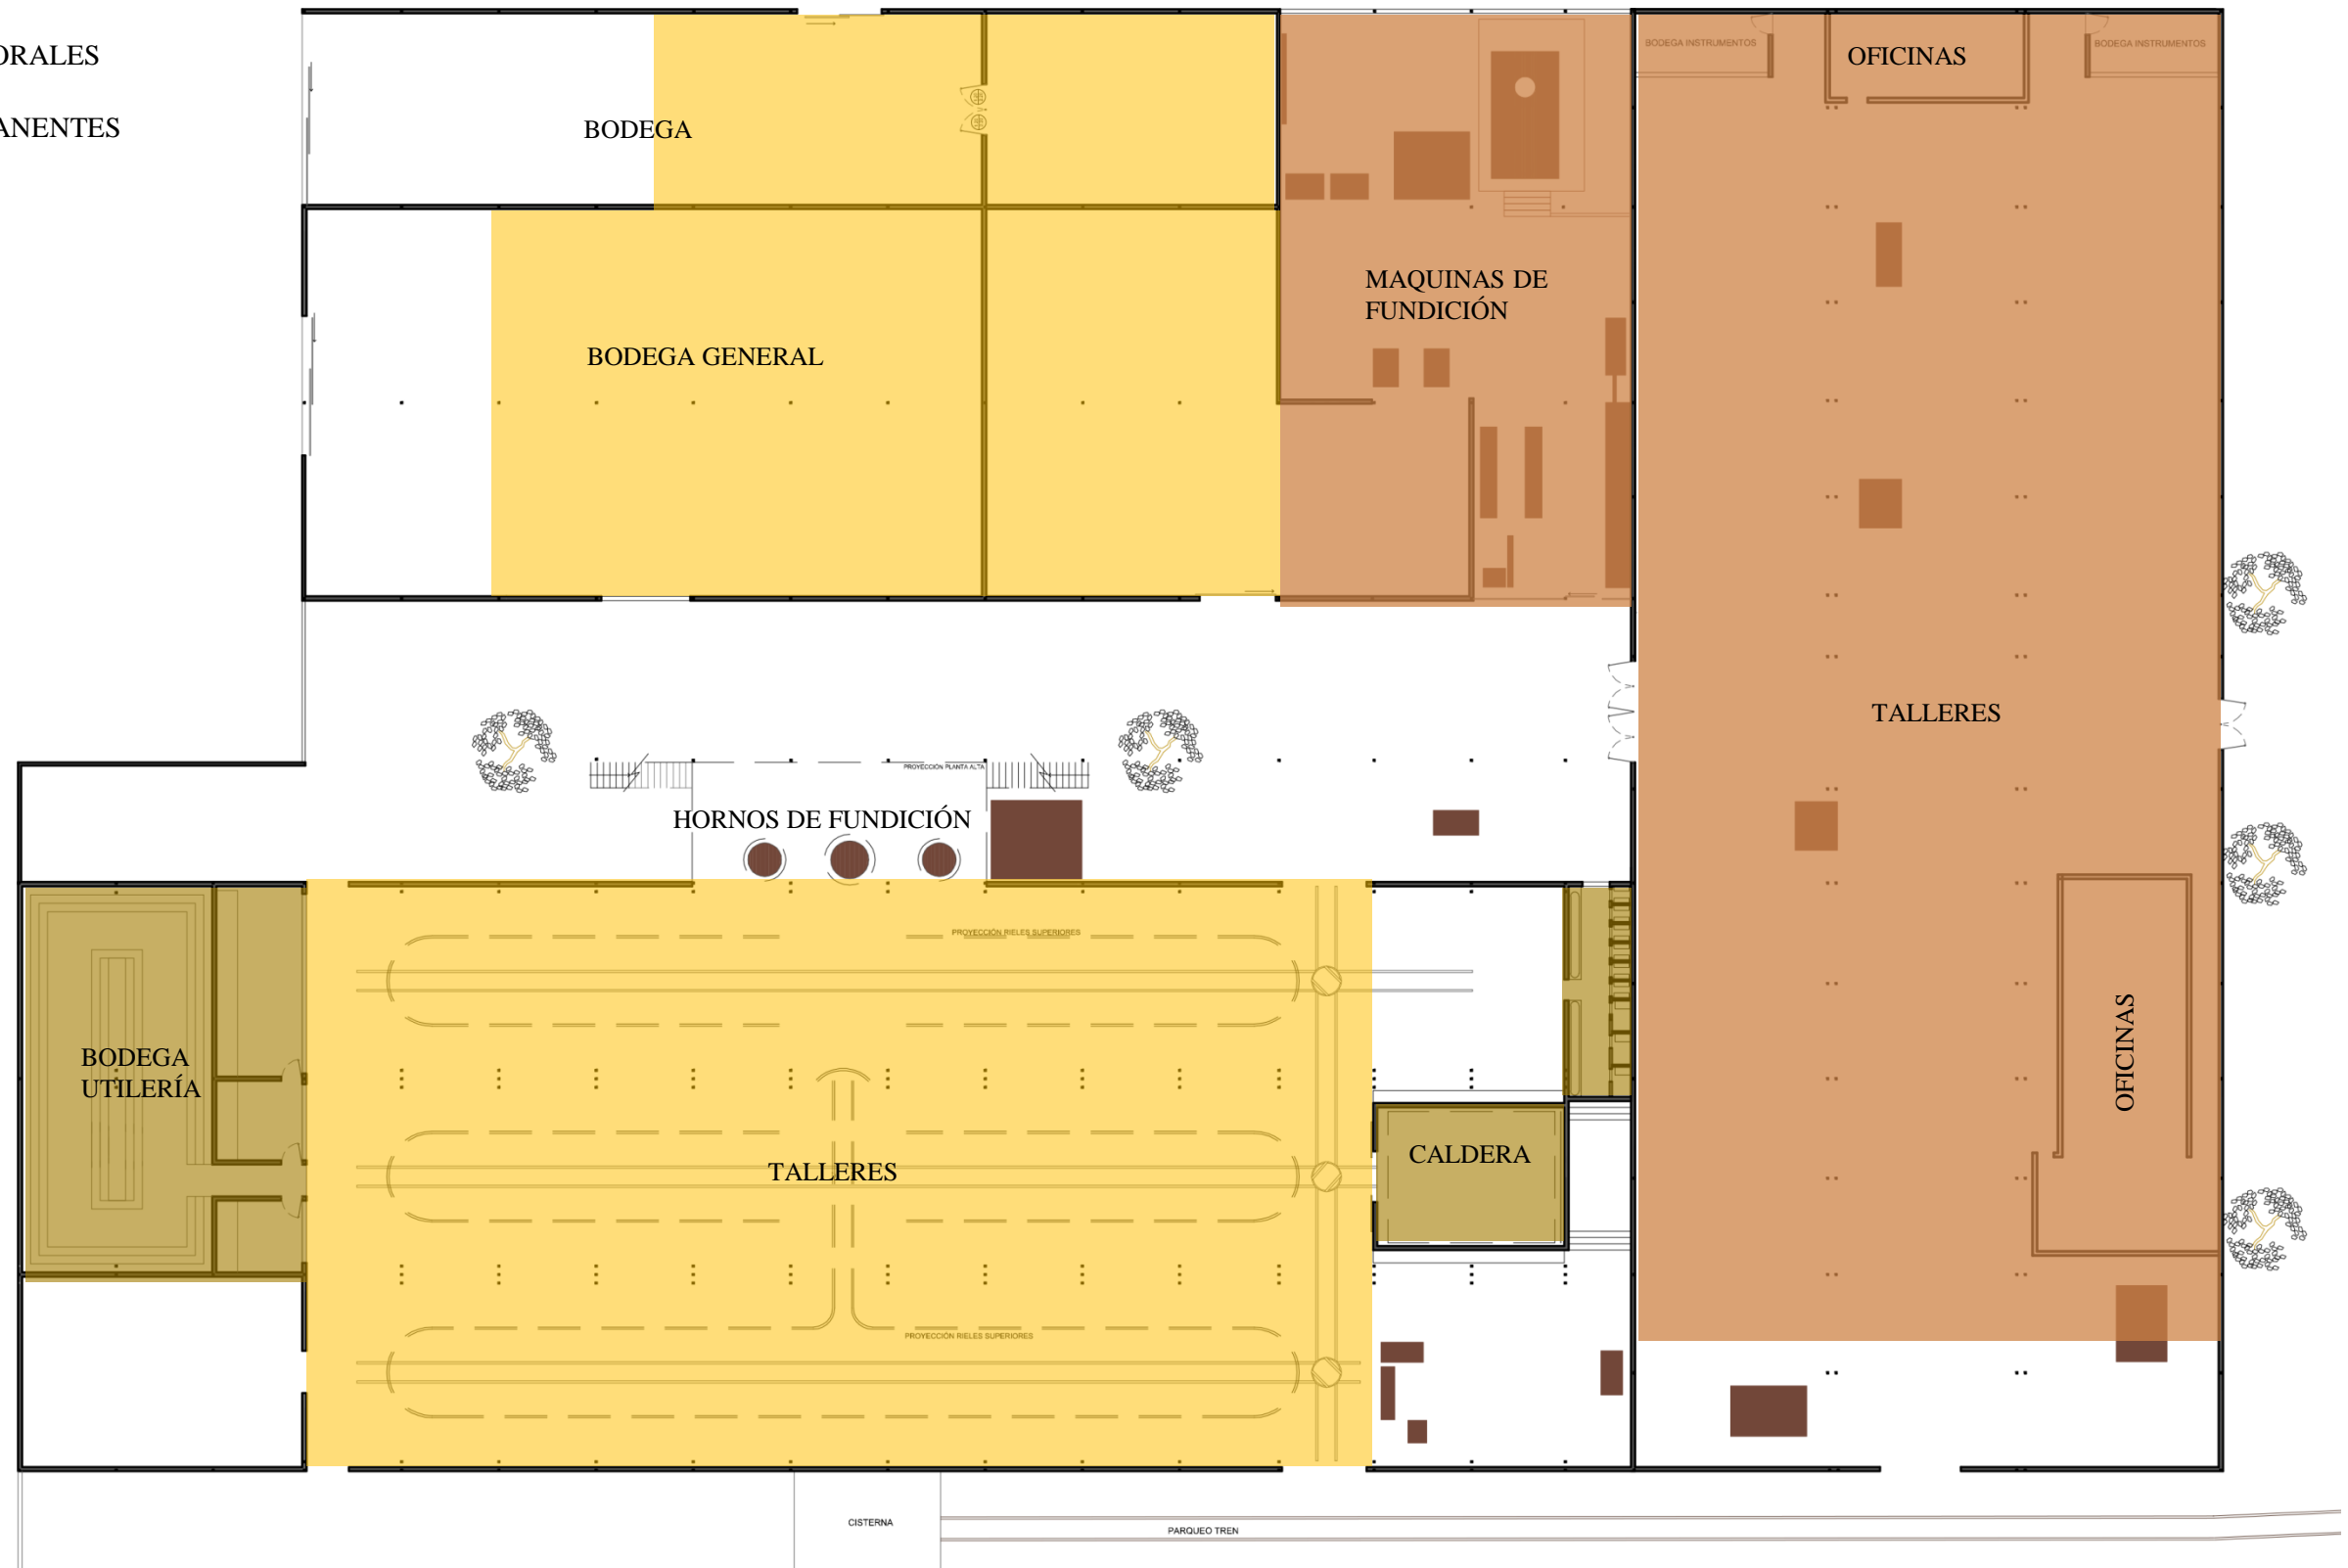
Planta actual zonificación por tipo de espacios a intervenir
